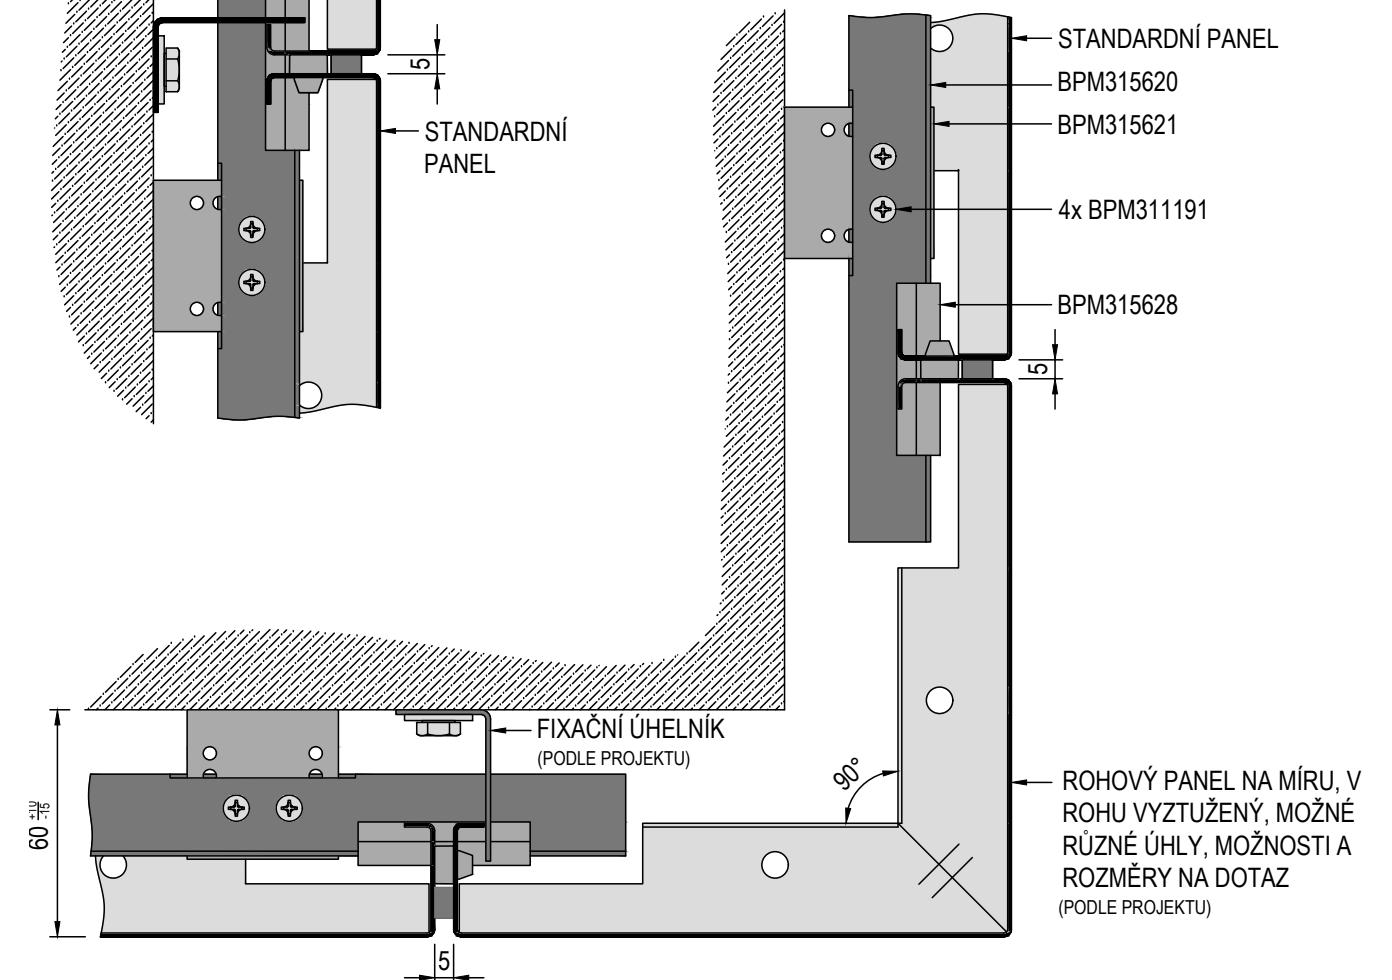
DETAIL VNĚJŠÍHO ROHU
